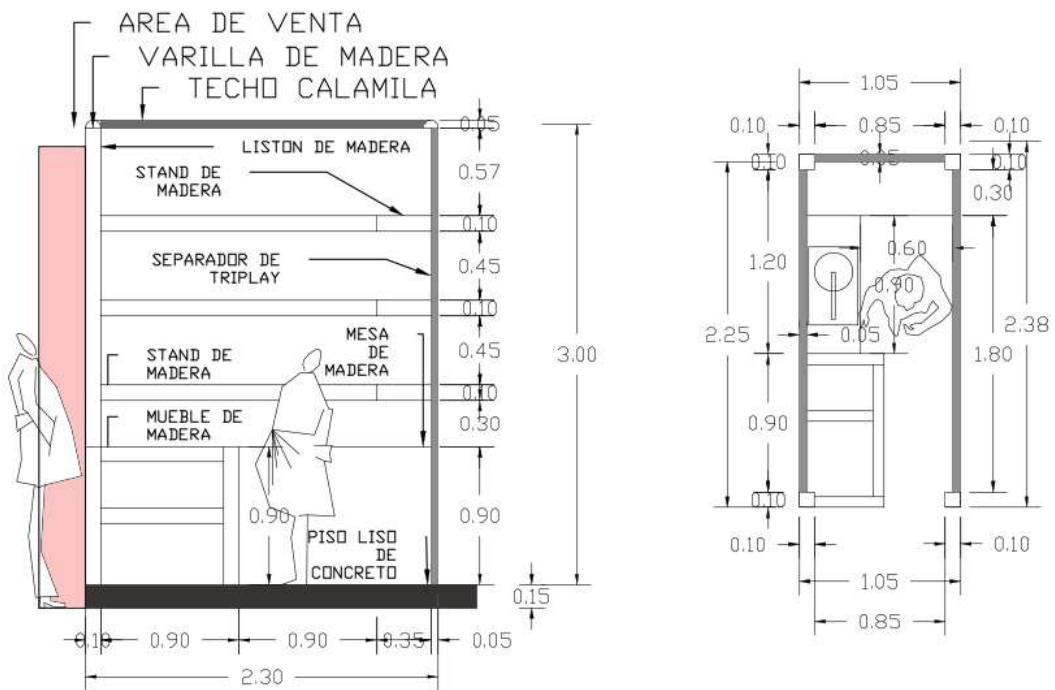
Corte Detallado y Planta de Abarrotes / Elaboración propia
